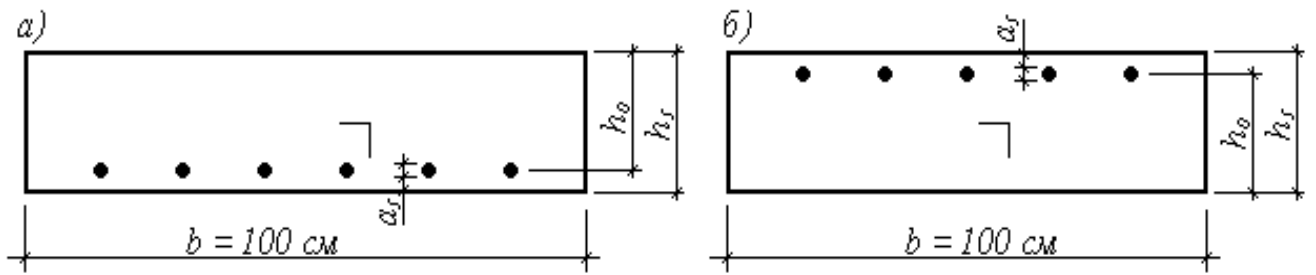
Розрахункові перерізи плити: а) в прольоті; б) на опорі
